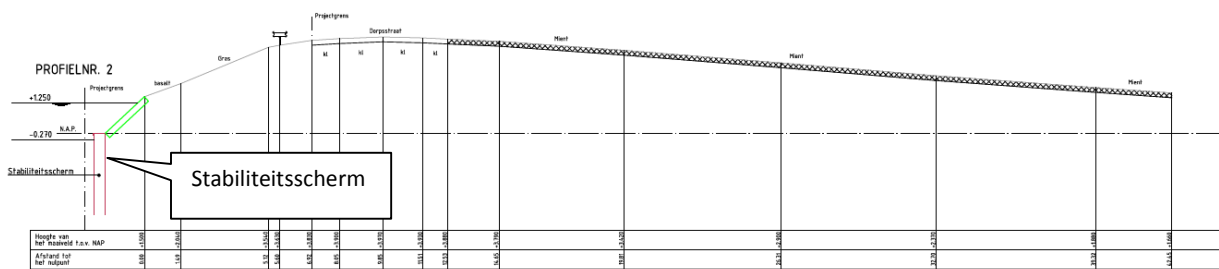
Constructie in de buitenteen - sectie 1a
